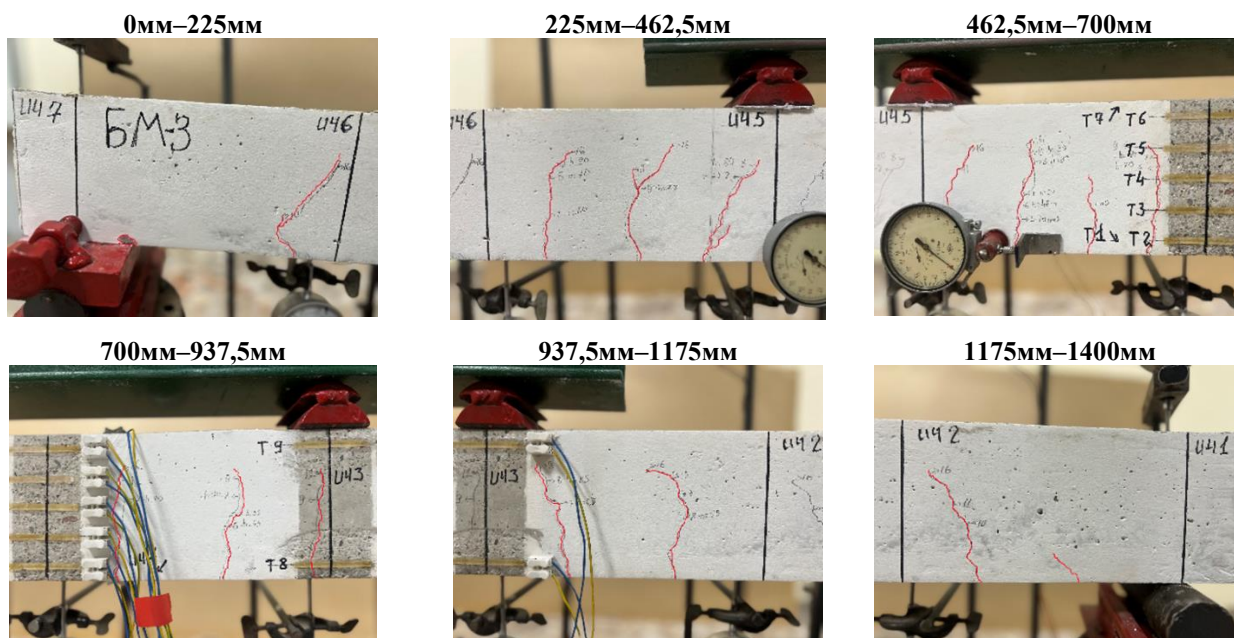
Типовая схема трещинообразования в модельной железобетонной балке
